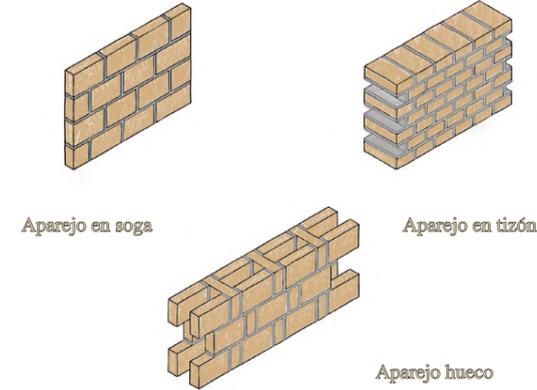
Tipos de aparejos con ladrillo macizo, Autoría propia, 2025
